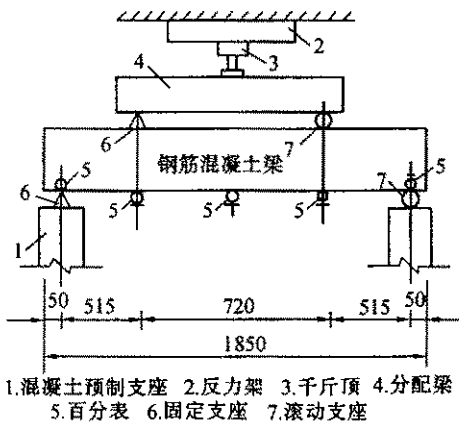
钢筋混凝土梁试验装置示意图(单位:mm)
